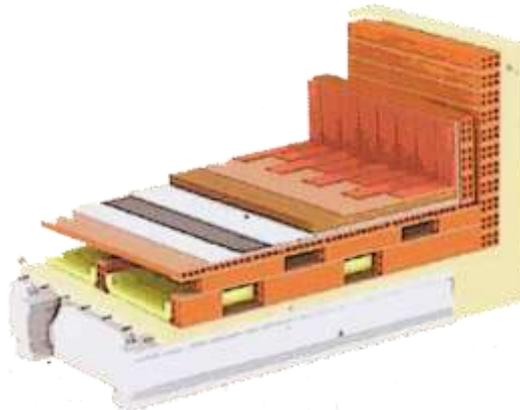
Cubierta plana, ventilada, transitable, tradicional.
